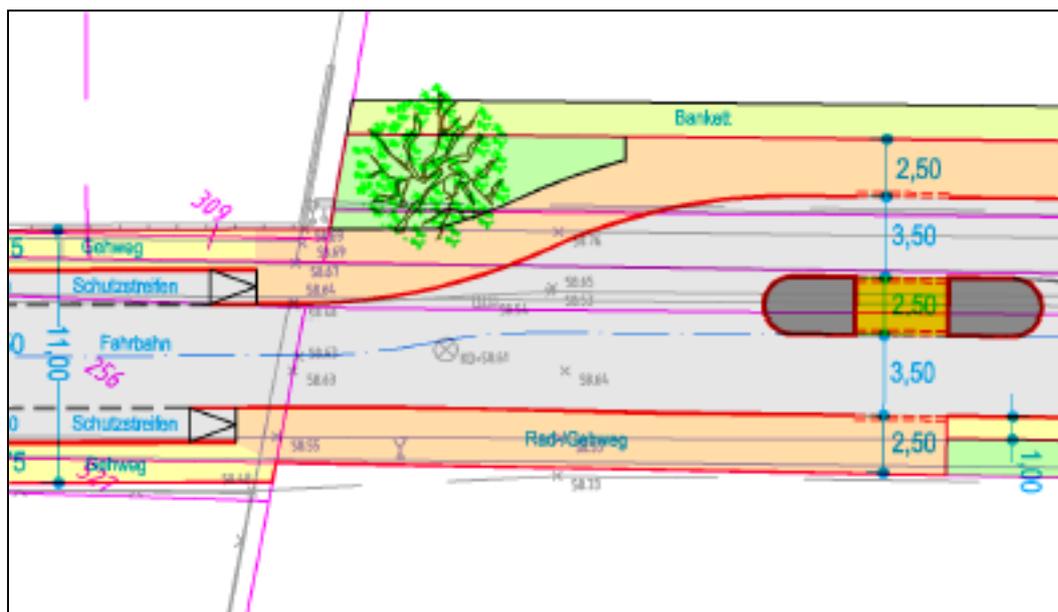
Planausschnitt Apostelpfad (Anschluss Zweirichtungsradweg)
